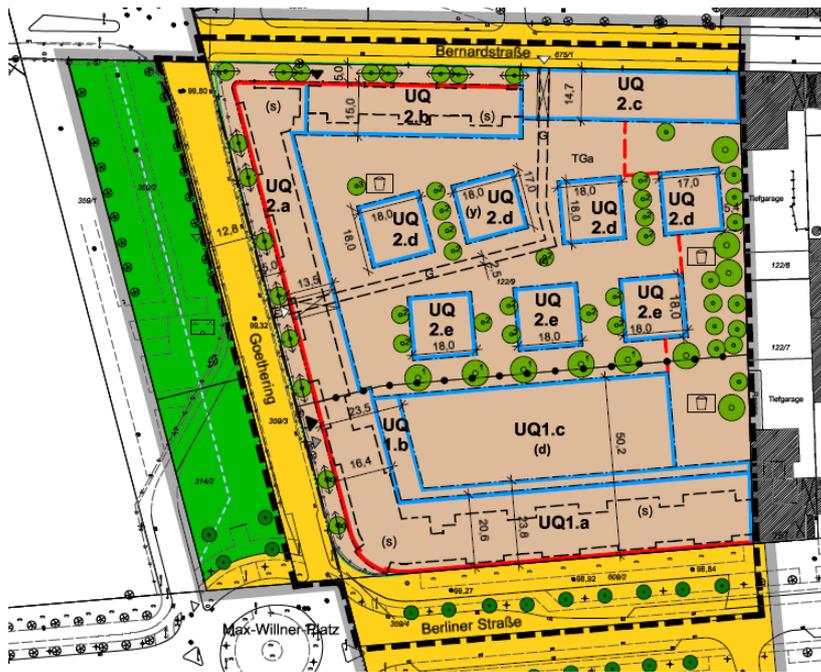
An das Plangebiet angrenzender Bebauungsplan Nr. 528 C (Quelle: Bebauungsplanübersicht Stadt Offenbach)
